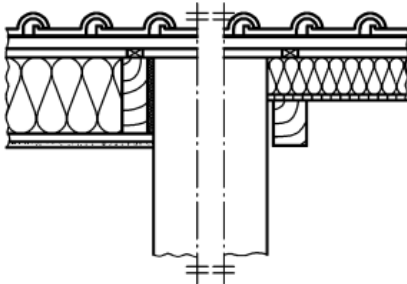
Schemaschnitt Einbindung von Innenwänden in Dachkonstruktion und Außenwand nach DIN 4109-33 [6]
